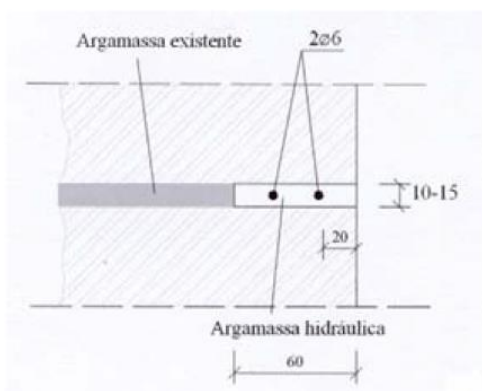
Pormenor de refechamento de juntas com armadura e aplicação de argamassa hidráulica (valores em mm)
